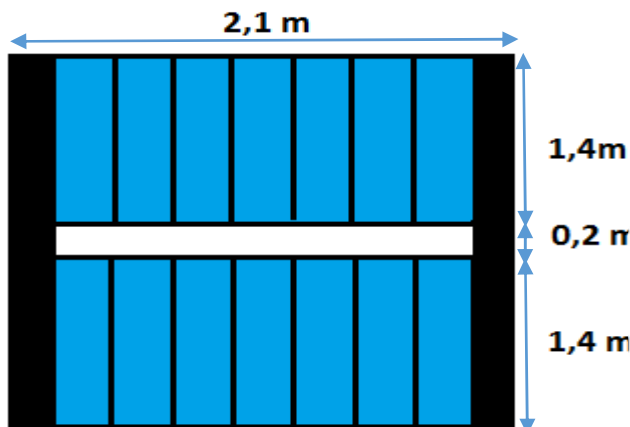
Vue en plan de l'escalier d'escalier droit à deux volée
